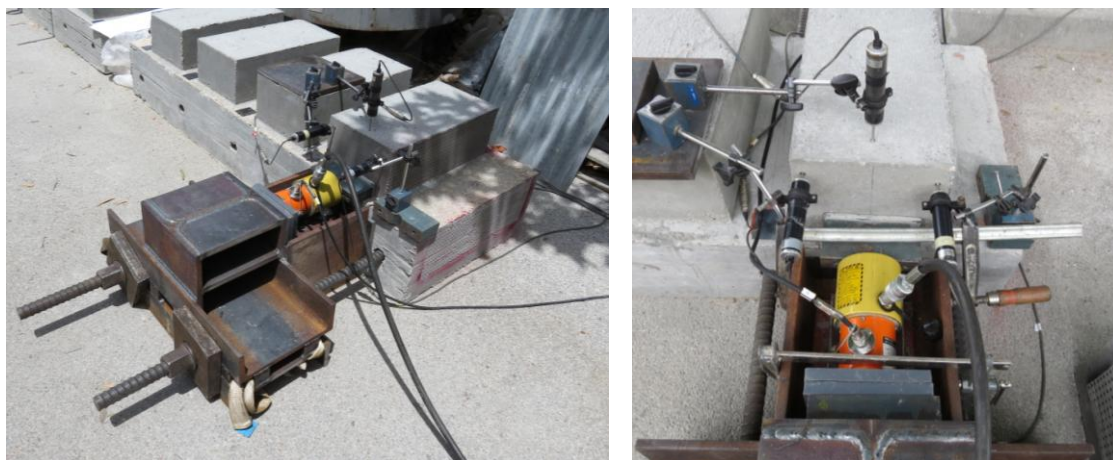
Setup* para ensaios de corte em laje (plano geral e pormenor dos instrumentos de monitorização)
